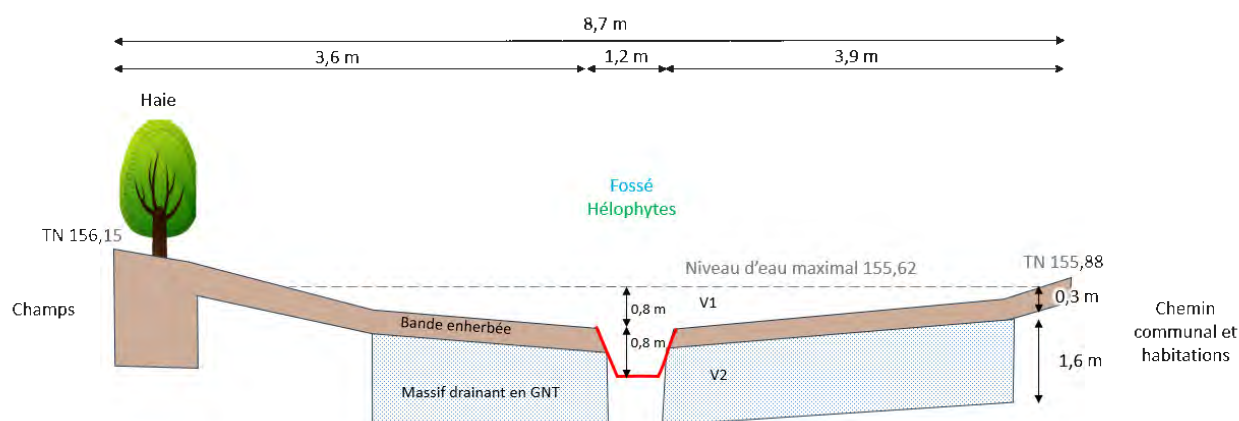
Schéma en coupe transversale de l'aménagement avec massif drainant
